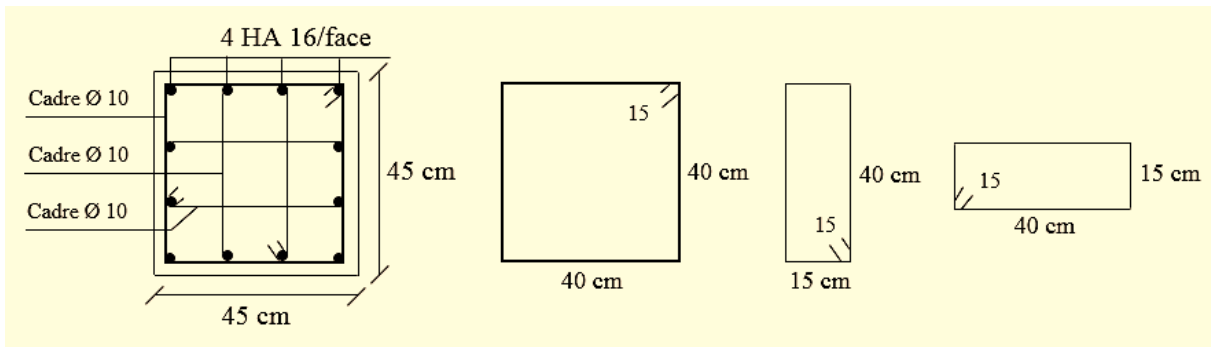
Coupe de ferrailage des poteaux 45×45 cm²
